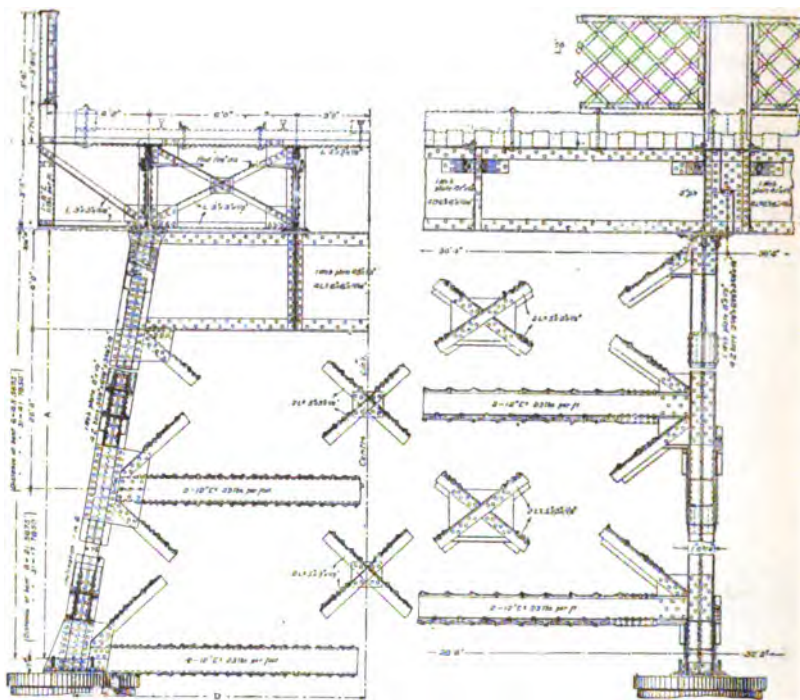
Pont de Bellefontaine. Viaduc d'accès (Rail Road Gazette).
